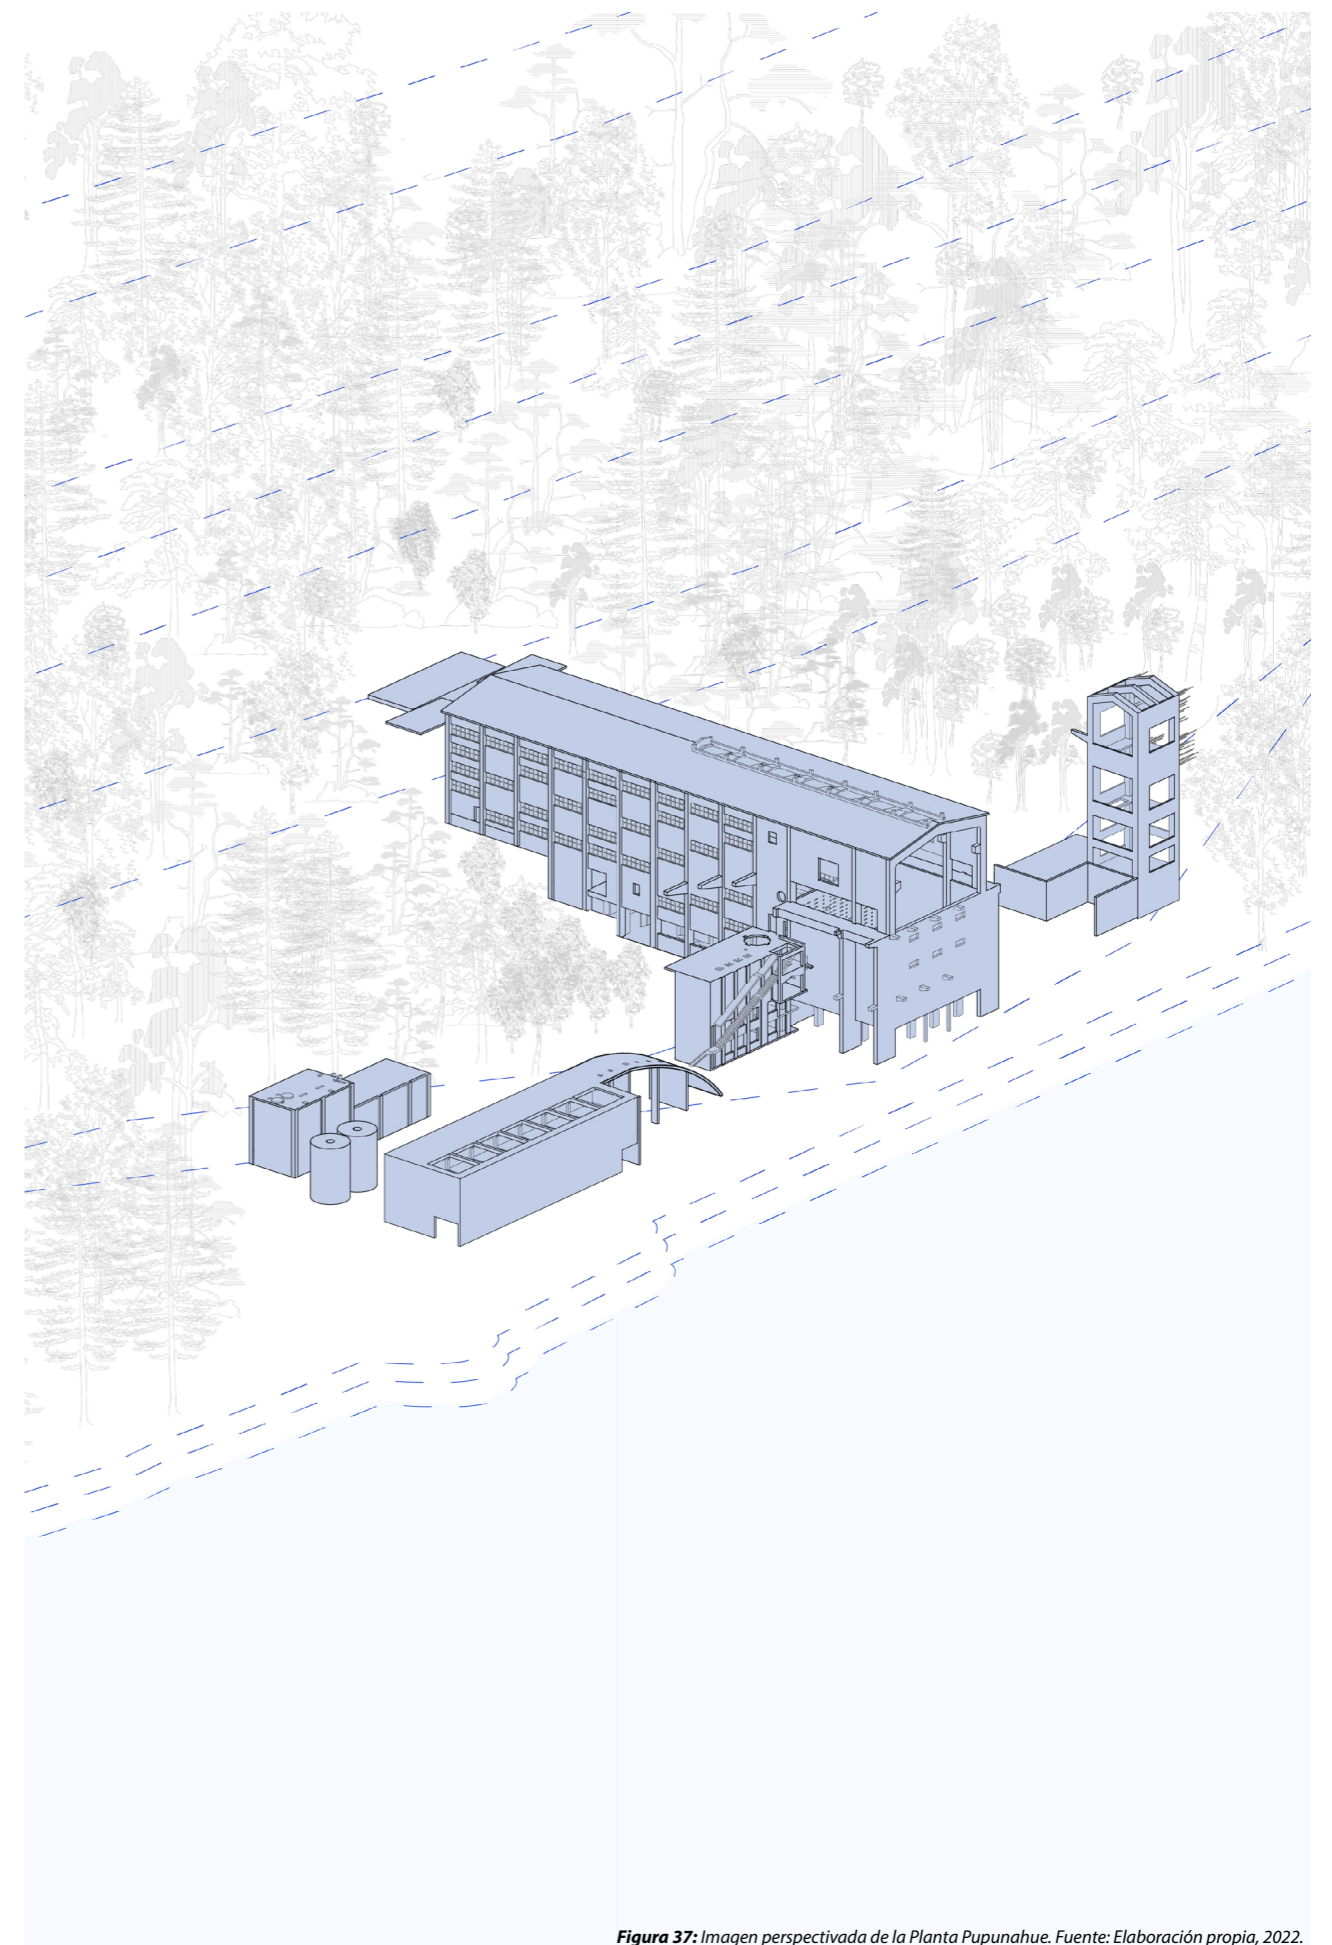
Imagen perspectivada de la Planta Pupunahue. Fuente: Elaboración propia, 2022.
